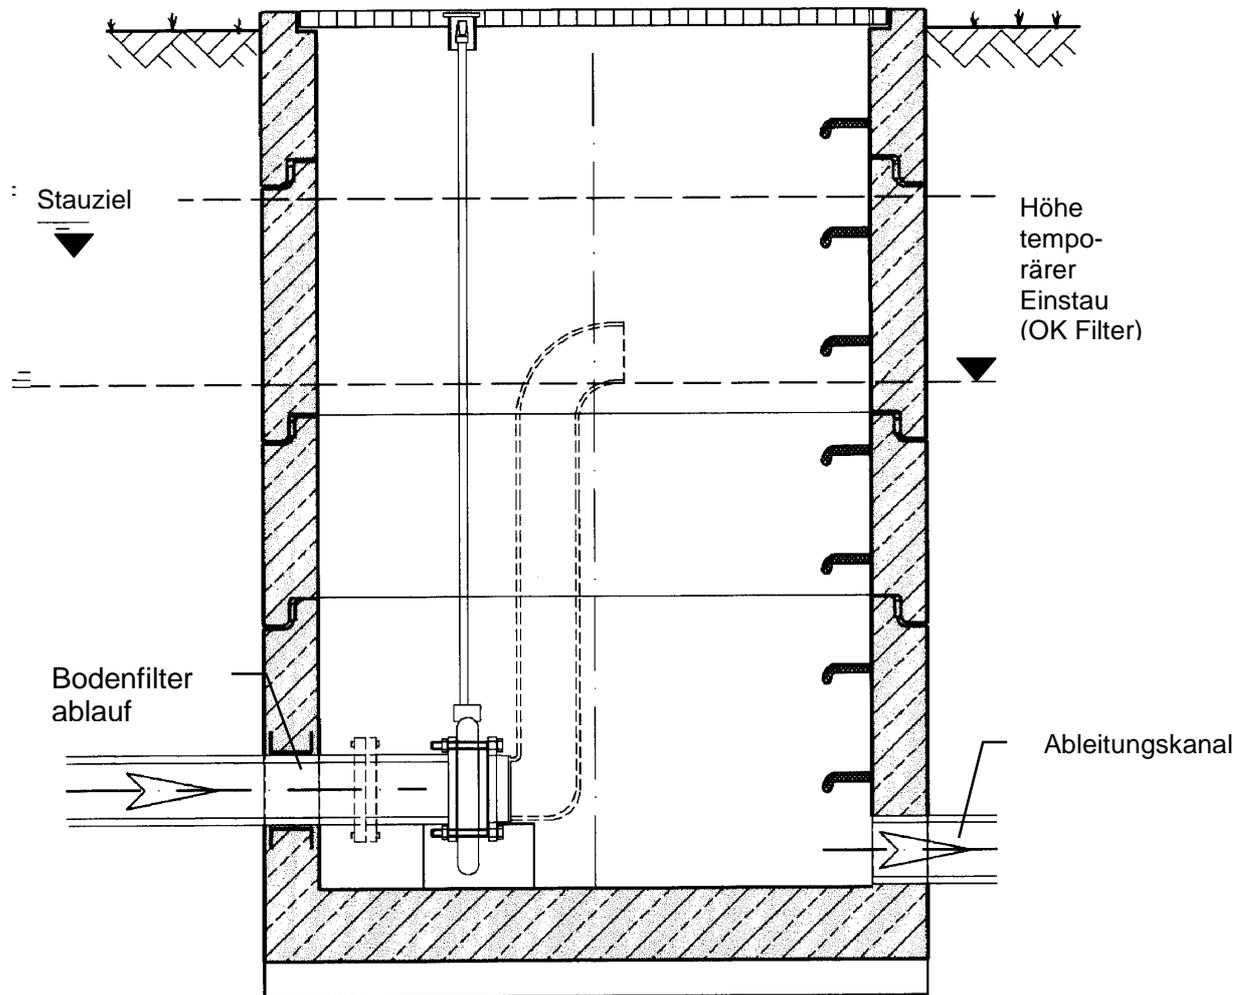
Schnitt durch das Ablaufbauwerk einer Filteranlage mit einer Vorrichtung zum temporären Einstau
